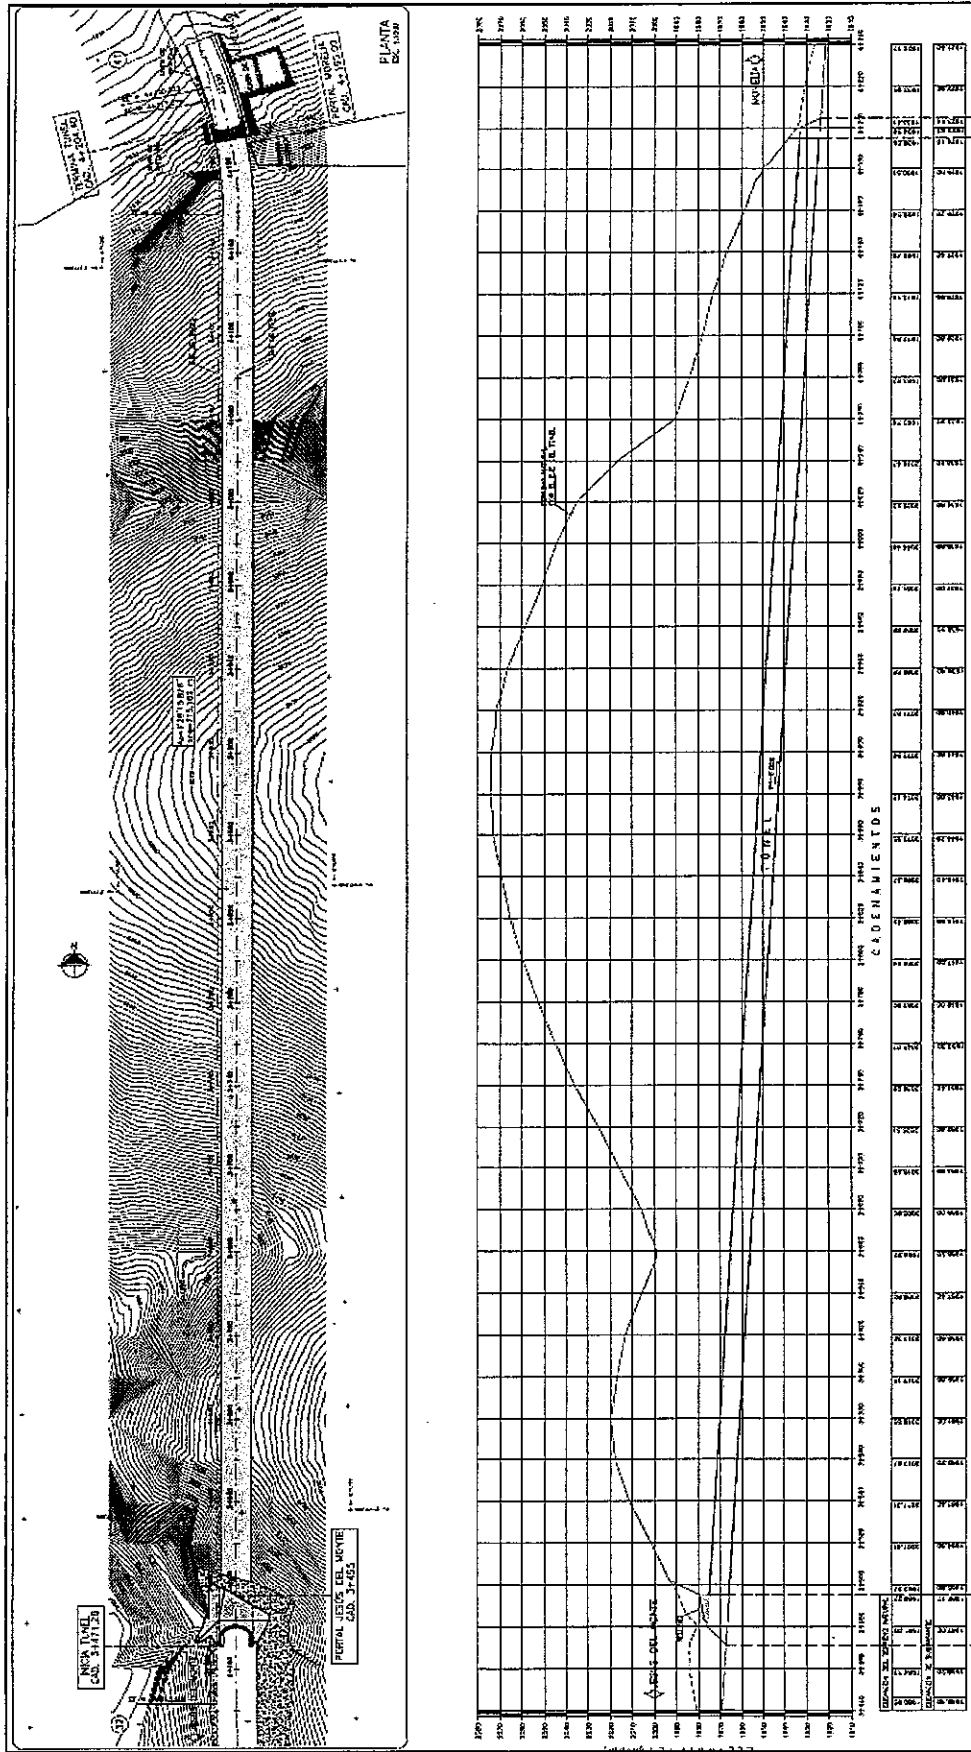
Planta topográfica y perfil longitudinal del Túnel II (Consultec, 2011)
